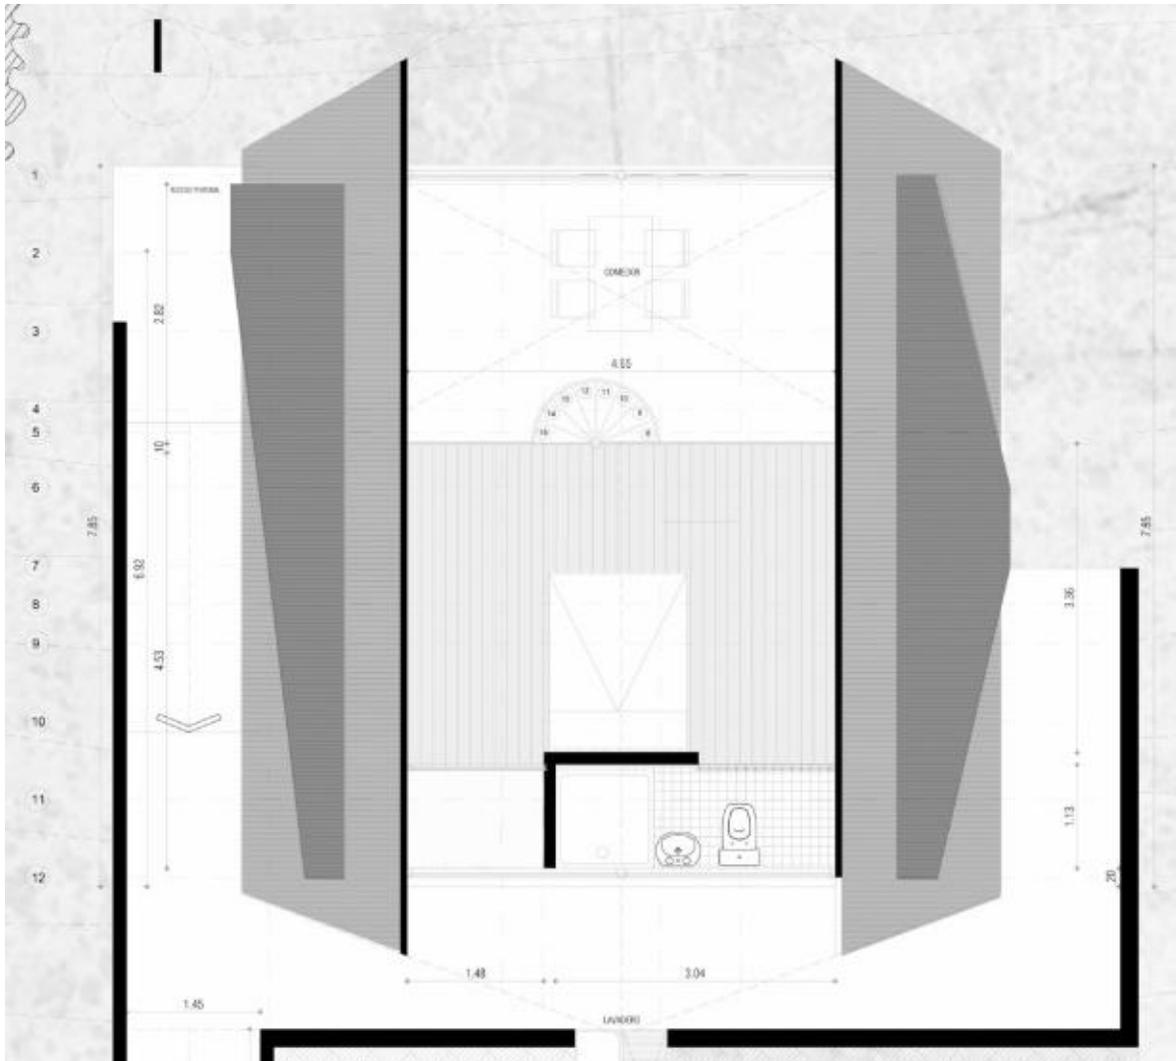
Planta Arquitectónica de Segundo Nivel
